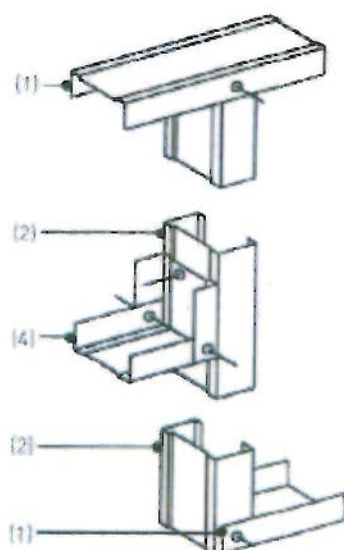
Pose d'une traverse pour traitement d'un joint horizontal (plaques BA - cloison à parement simple
